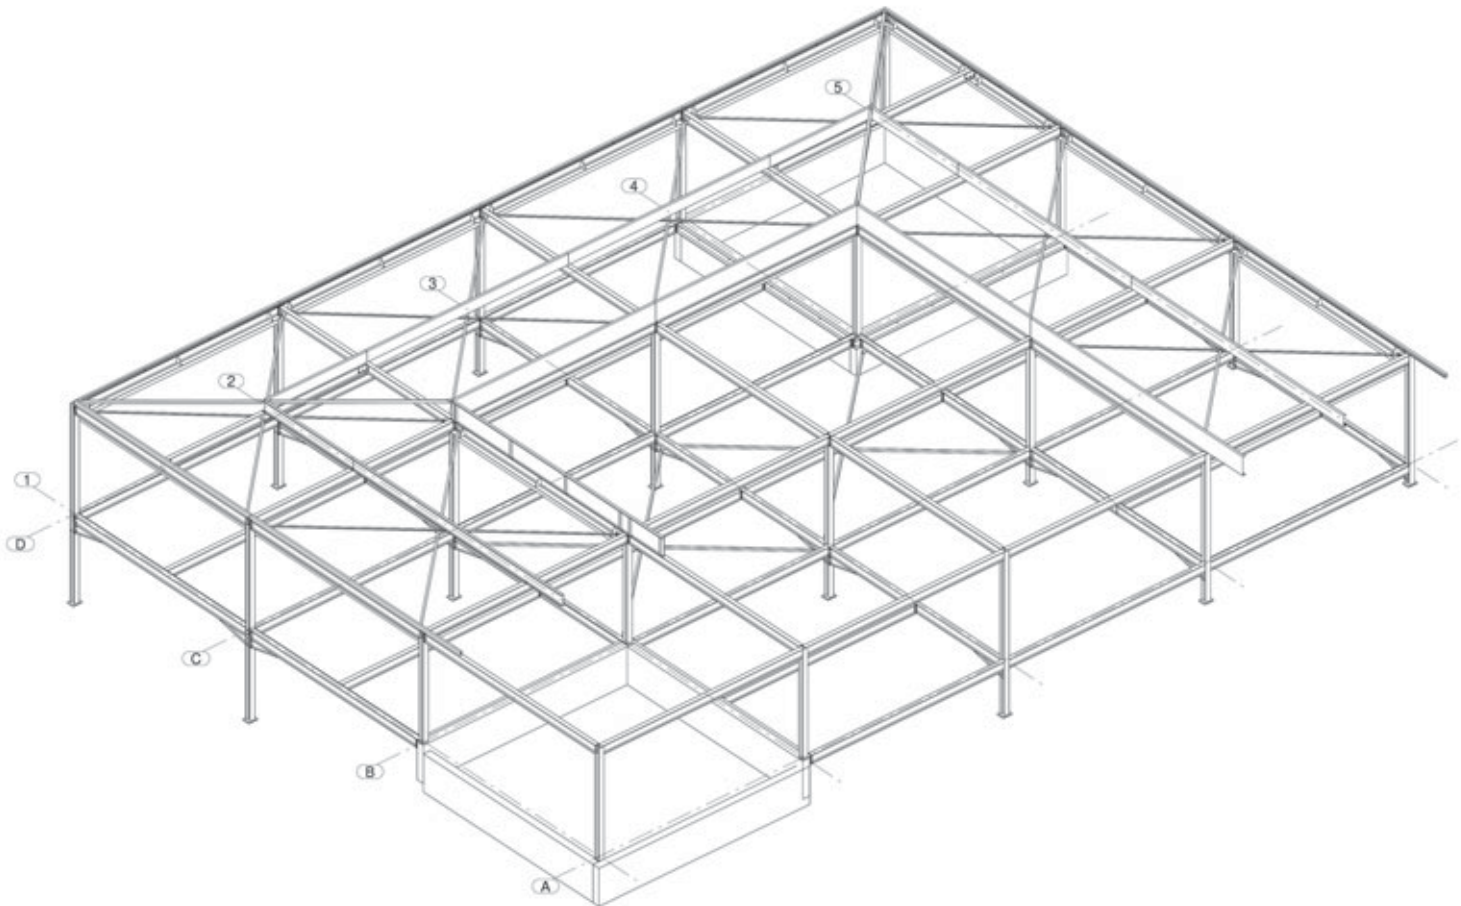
| Assonometria d'assieme della carpenteria metallica e degli elementi strutturali.
